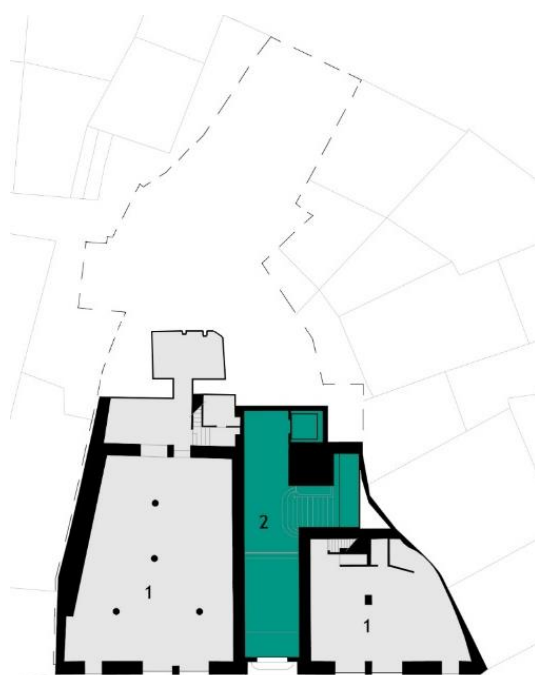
Caracterização de espaços da planta de projeto para o Piso 0
